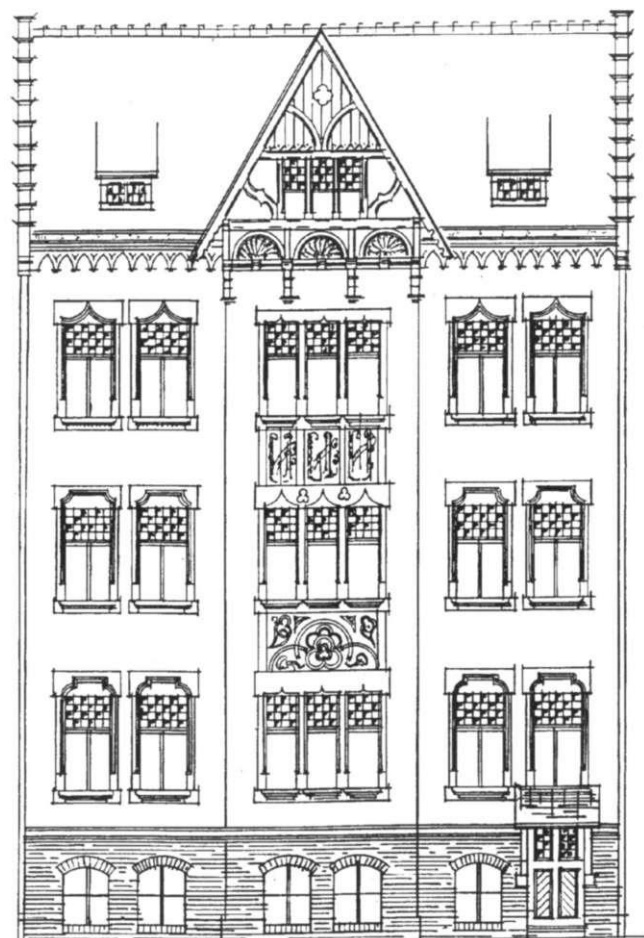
Fassadenaufriß des Badehauses Gerhart-Hauptmann-Straße 32
